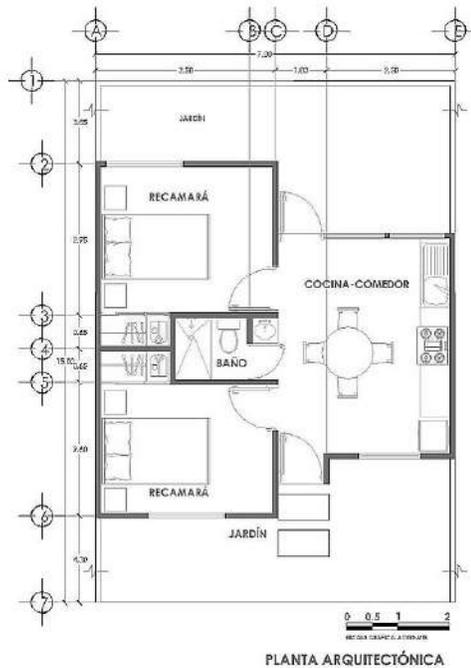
Planta arquitectónica de la vivienda prototipo Roma-106. Fuente: Los autores
